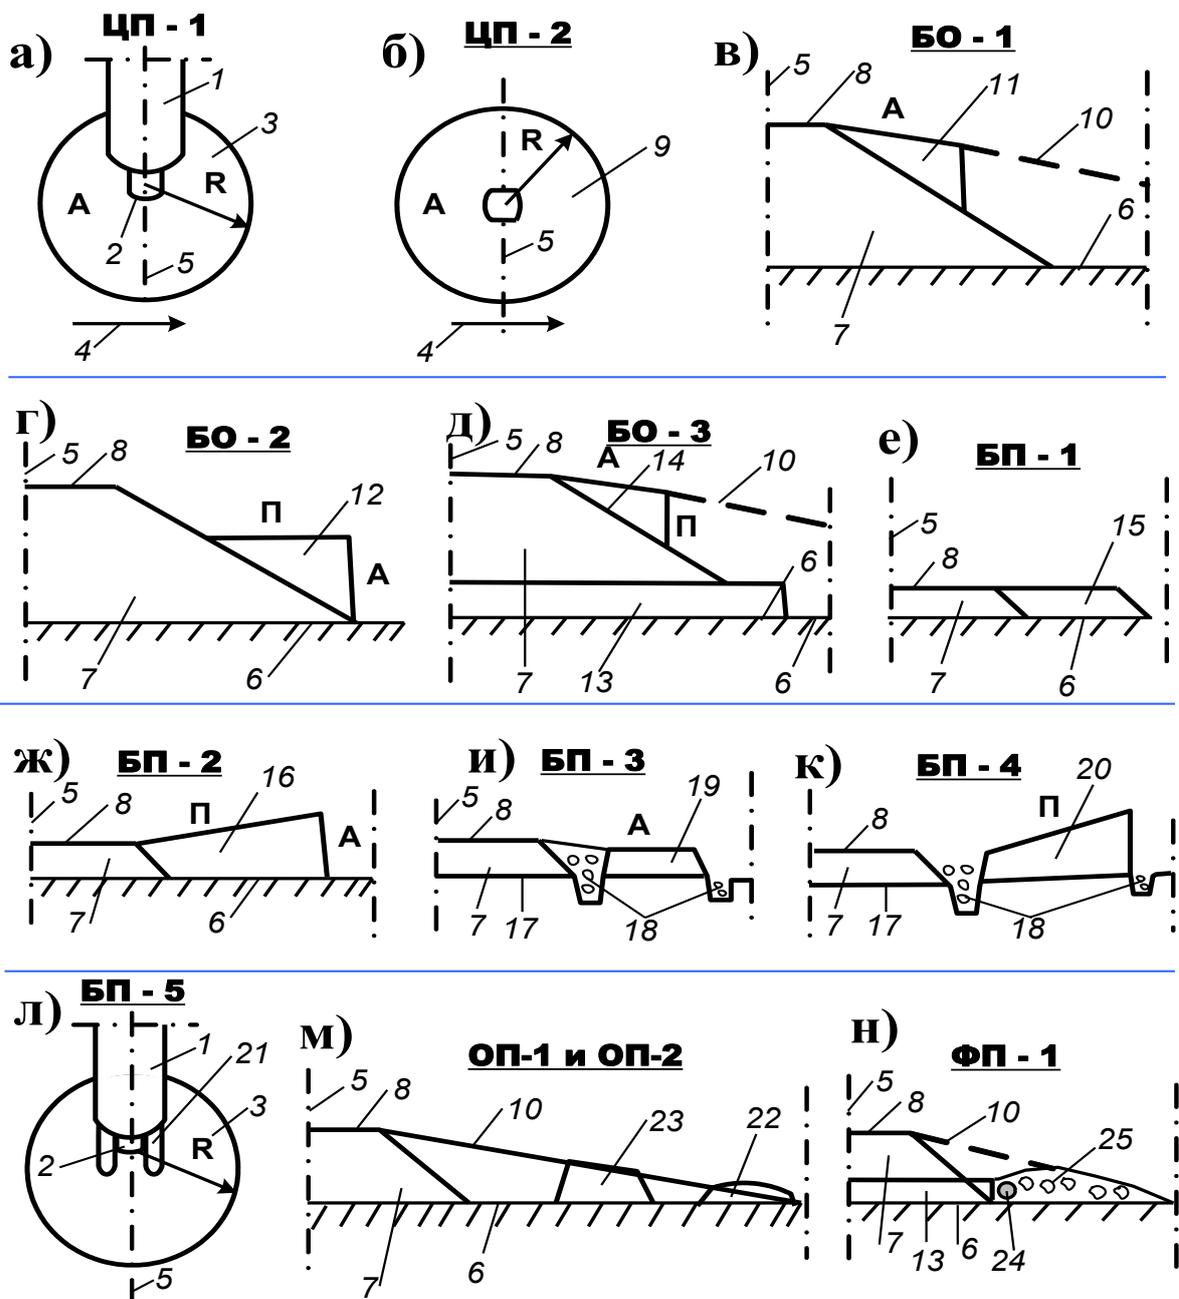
Принципиальная схема охлаждающих площадок: 1 – подходная часть насыпи, 2 - устой моста, 3 – охлаждающая площадка ЦП-1, 4 – направление русла водотока, 5 – ось дороги, 6 – естественная поверхность грунта, 7 – тело насыпи, 8 – основная площадка насыпи, 9 – охлаждающая площадка ЦП-2, 10 – поверхность снежных отложений, 11 – охлаждающая площадка БО-1, 12 - охлаждающая площадка БО-2, 13 – водопропускная труба, 14 - охлаждающая площадка БО-3, 15, 16 - охлаждающие площадки БП-1 и БП-2, 17 – поверхность грунта выемки, 18 – кювет, 19, 20, 21, 22, 23 – охлаждающие площадки БП-3, БП-4, БП-5, ОП-1, ОП-2, 24 – поперечная водосборная труба, 25 – охлаждающая площадка ФП-1.
